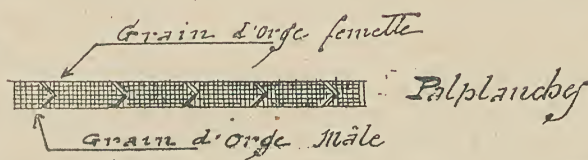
Plan de palplanches avec assemblages à grain d'orge (mâle et femelle).
